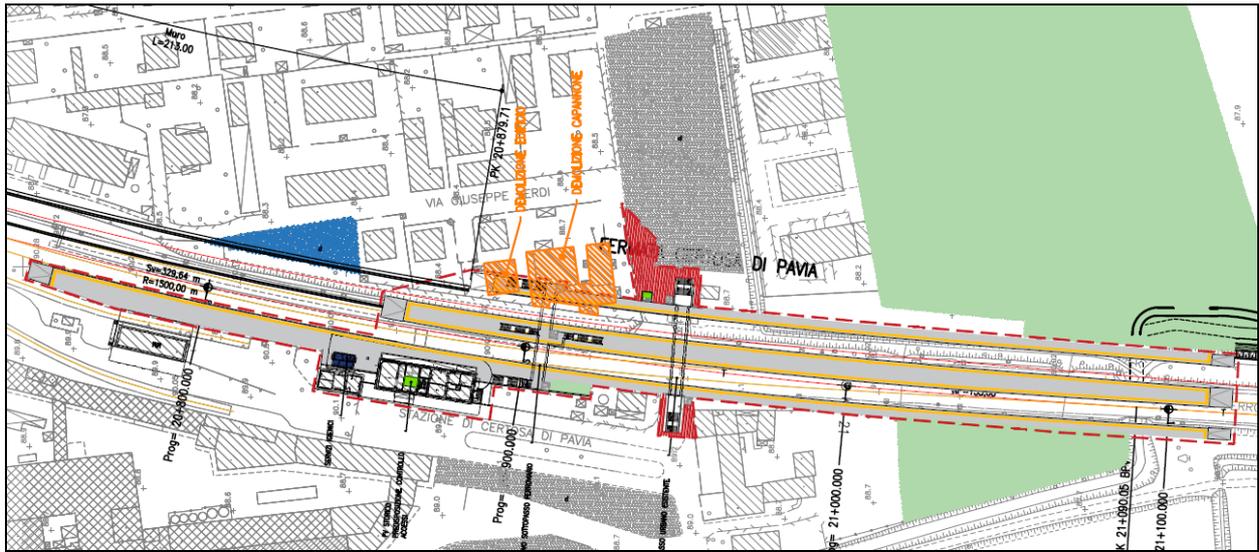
Pianta relativa agli interventi da effettuare nella stazione di Certosa di Pavia.
